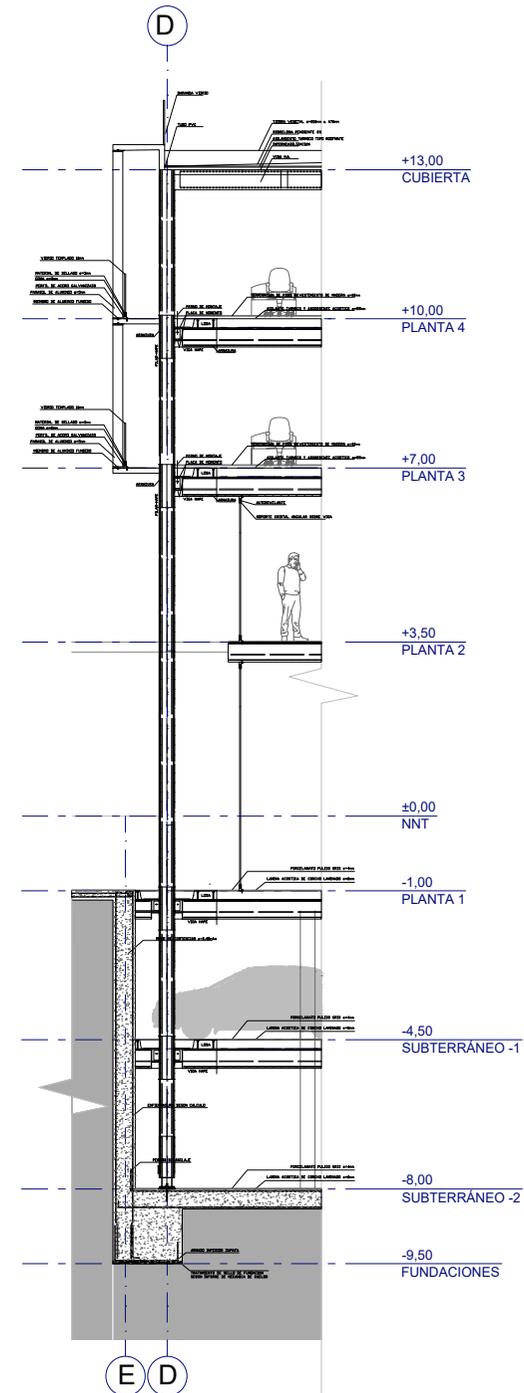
Escantillón eje 5. Fuente: Elaboración propia
